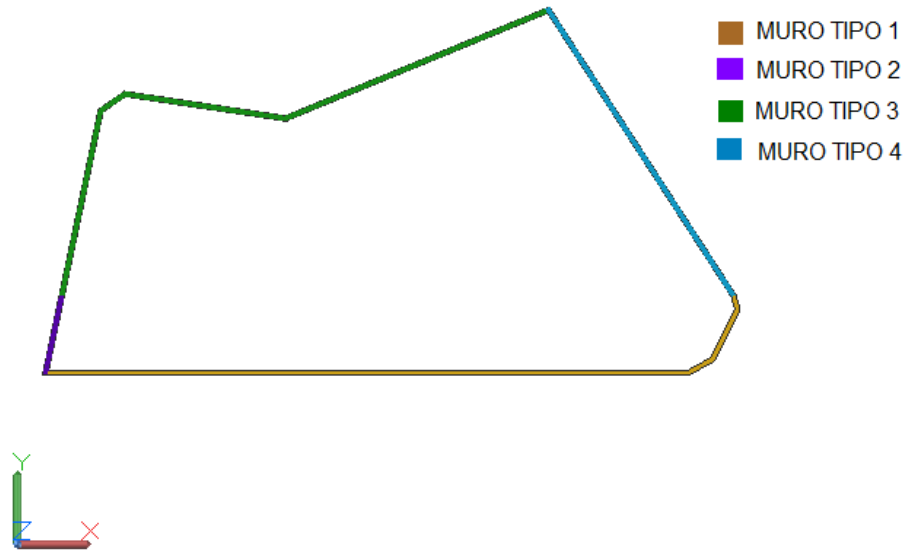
Vista en planta de los muros tipo. AutoCAD Civil 3D.
